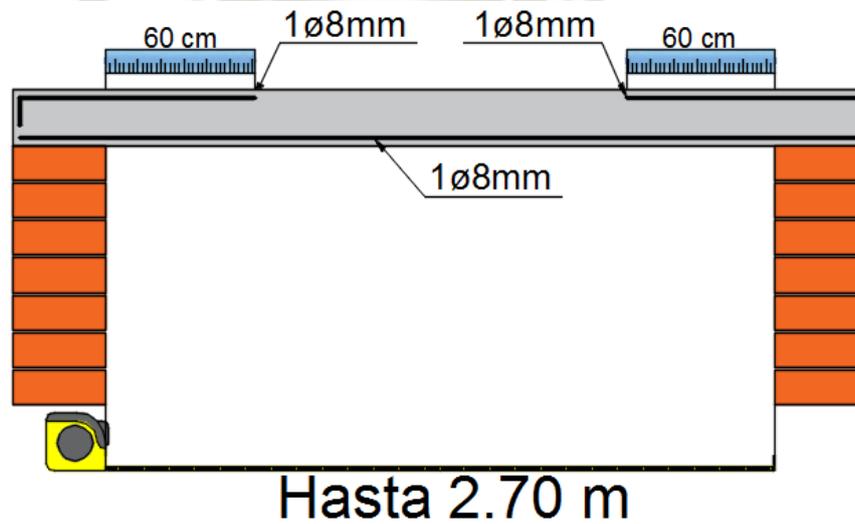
Refuerzo en vigueta hasta 2.70 m.
